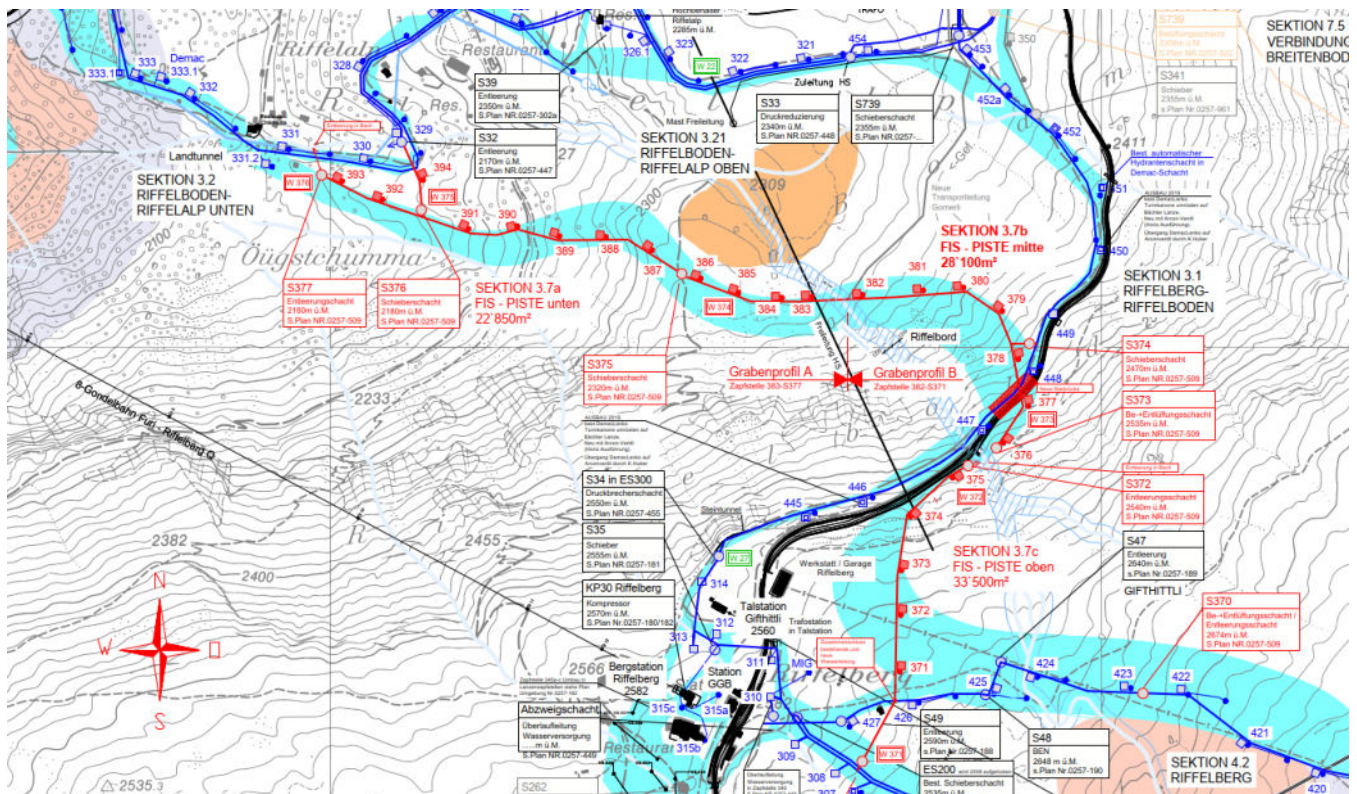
Ausschnitt Schneeanlage Situation Brigger + Käch
